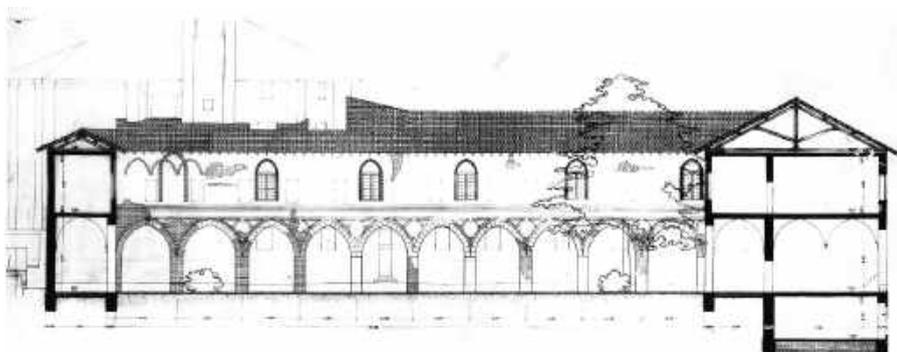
Sezione del chiostro ovest, progetto di restauro
